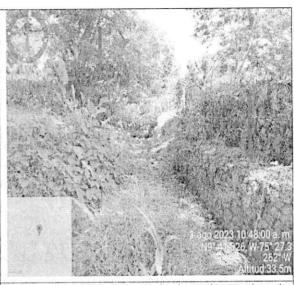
Vista del punto donde se observa obras de protección geotécnica en muro de gaviones. Además vista del individuo arbóreo localizado en el punto E: 848799 – N: 1562938de 80 cm de DAP y 10 m de altura aproximadamente
